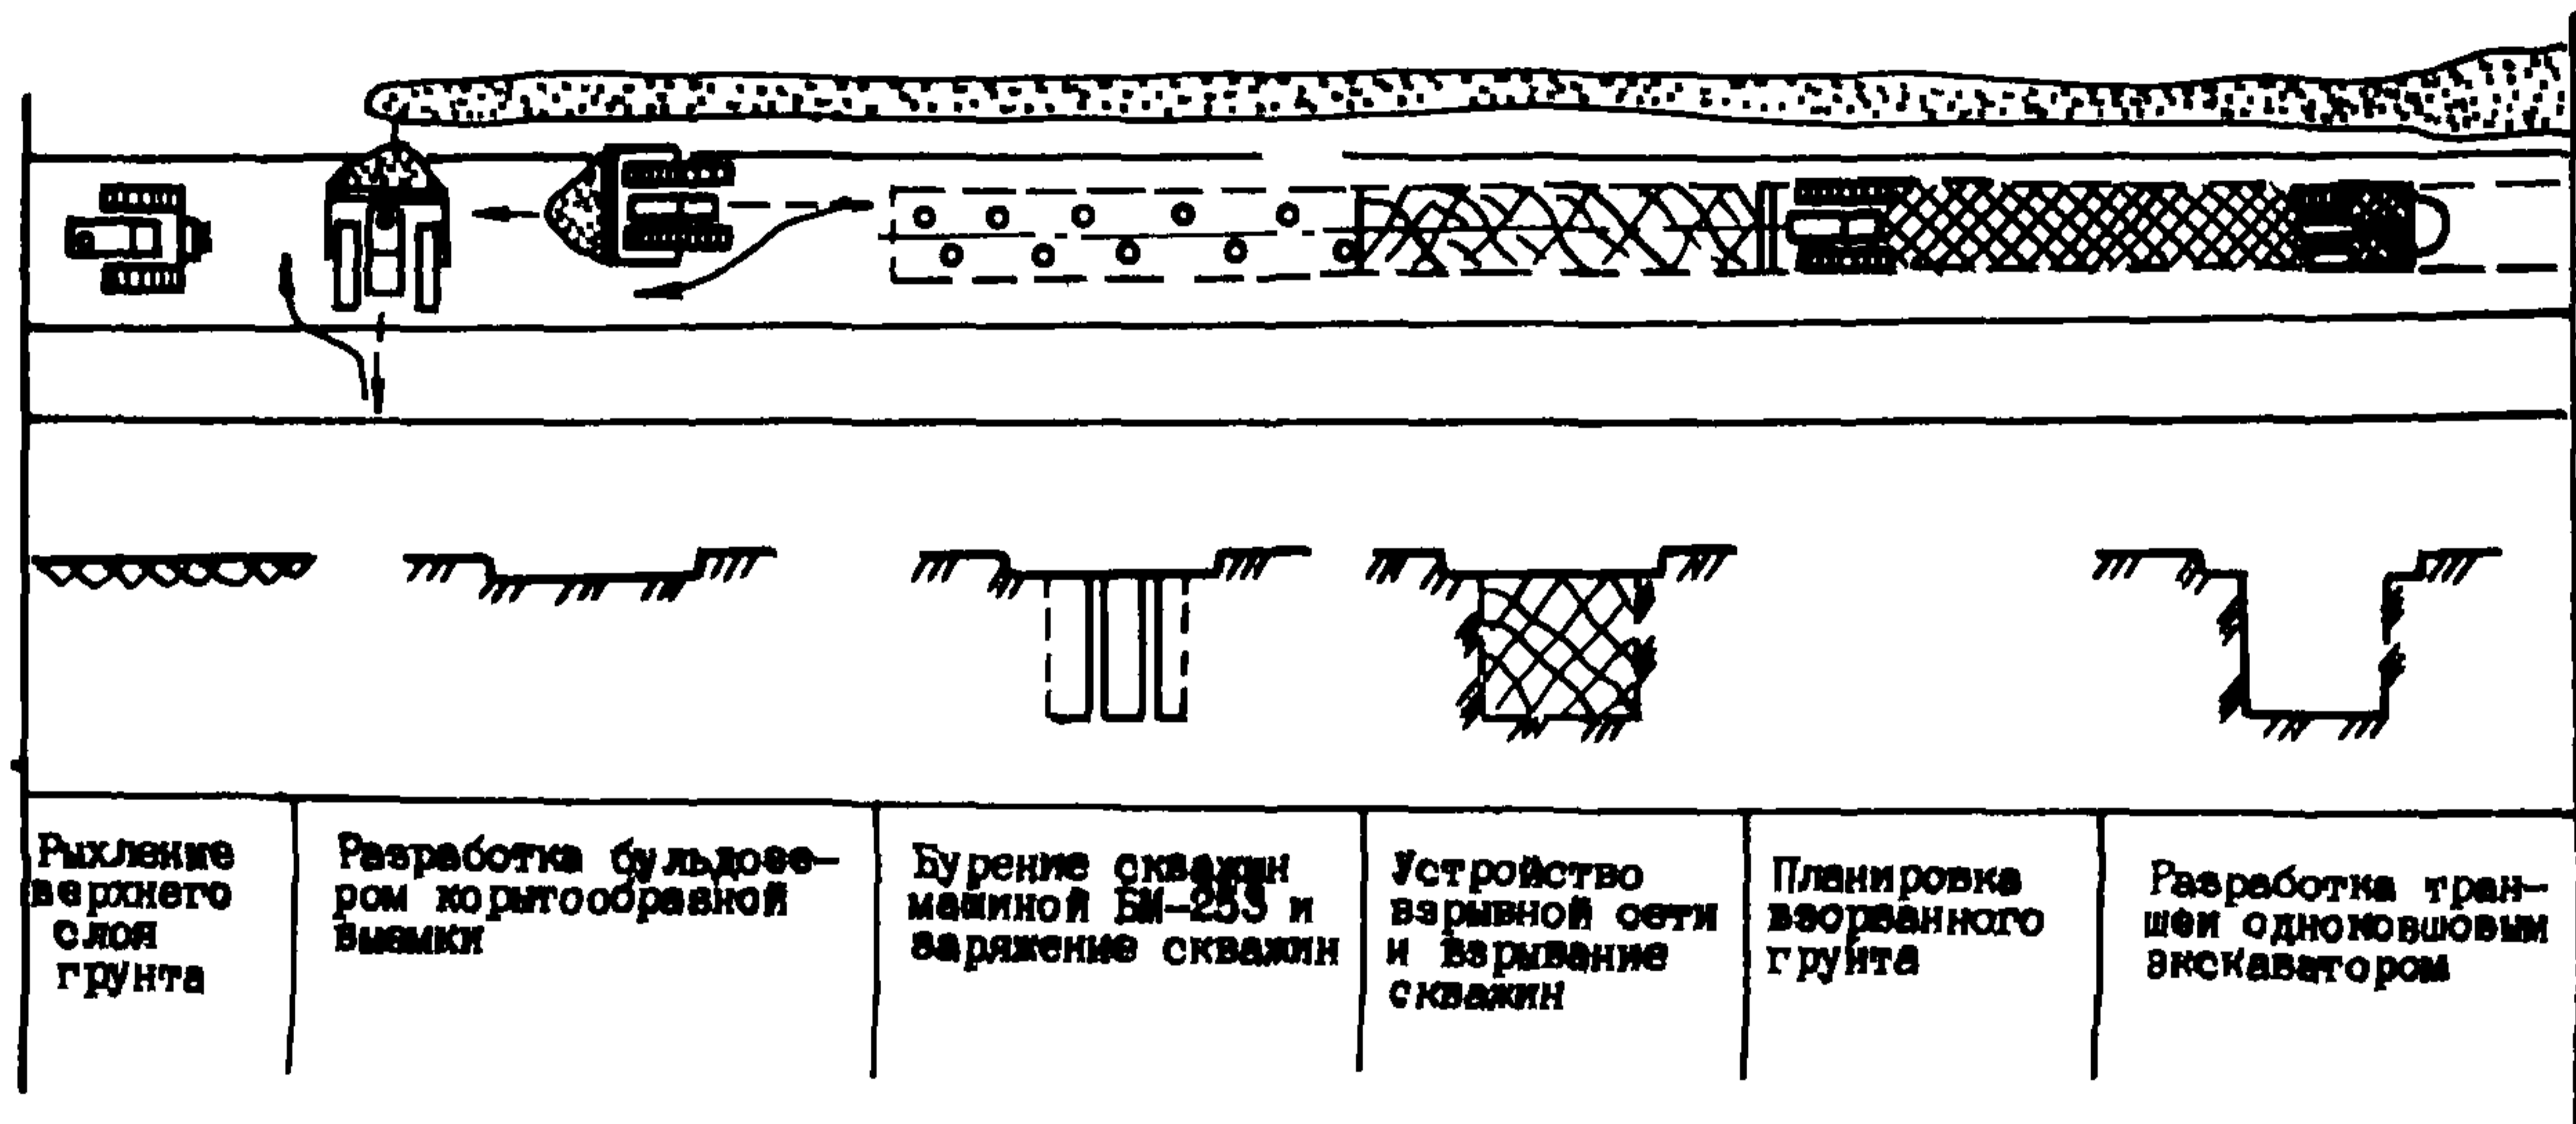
Разработка траншей в мерзлых грунтах крепостью более 400 ударов плотномер ДорНИИ с рыхлением грунта буро-взрывным способом
